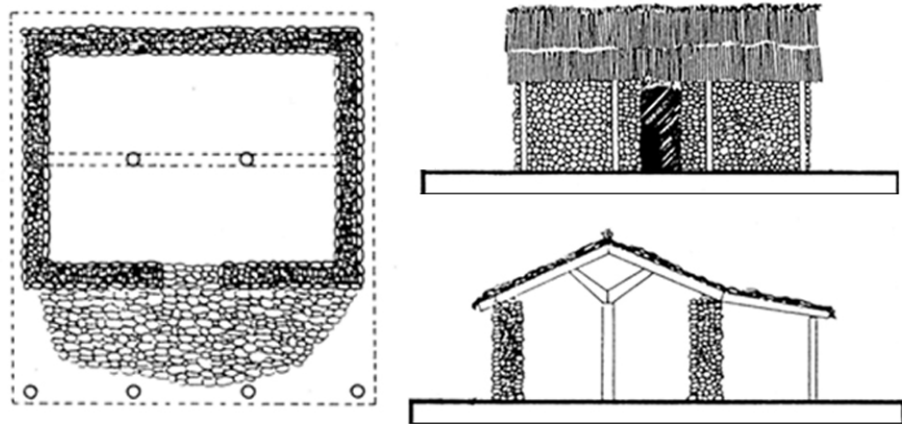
Elevación, Corte y planta esquemática de Hare paenga. Fuente: Budd, Vargas, 1992.
